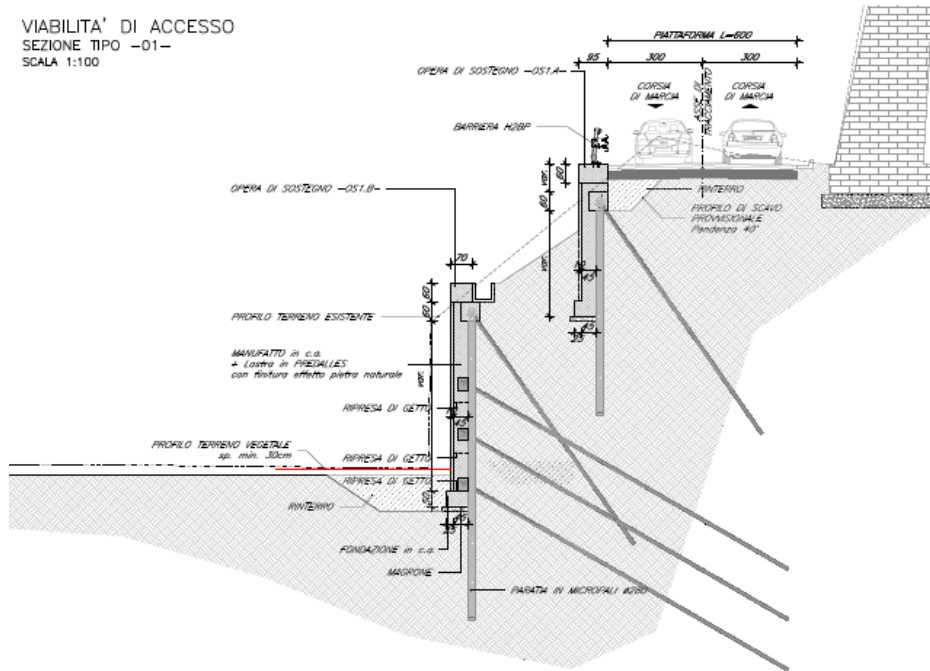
Viabilità di accesso – Sezione tipologica 1
